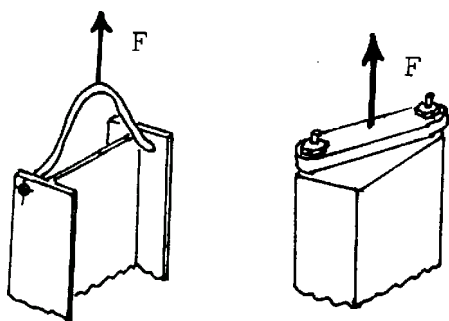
SOLICITAÇÕES EM VIGA DE PAREDES DELGADAS E VIGA SÓLIDA
